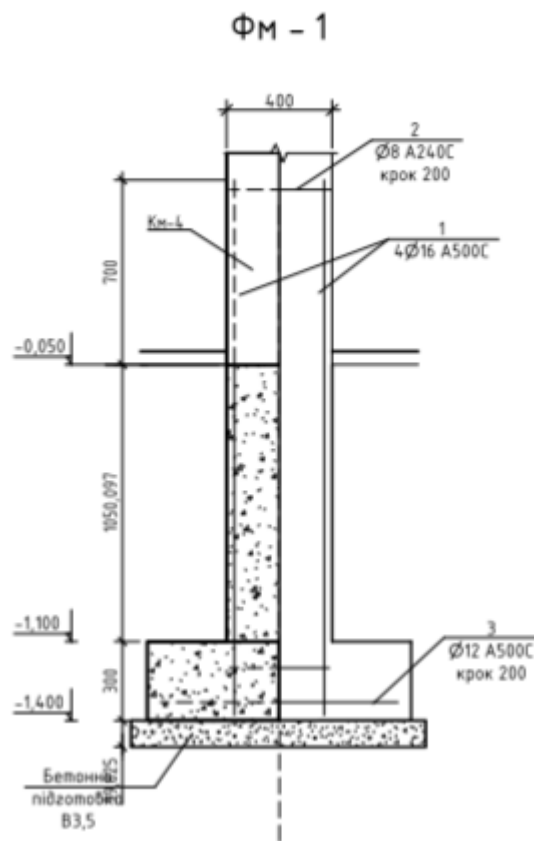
Армвання фундаменту, каркас просторовий КП-1
